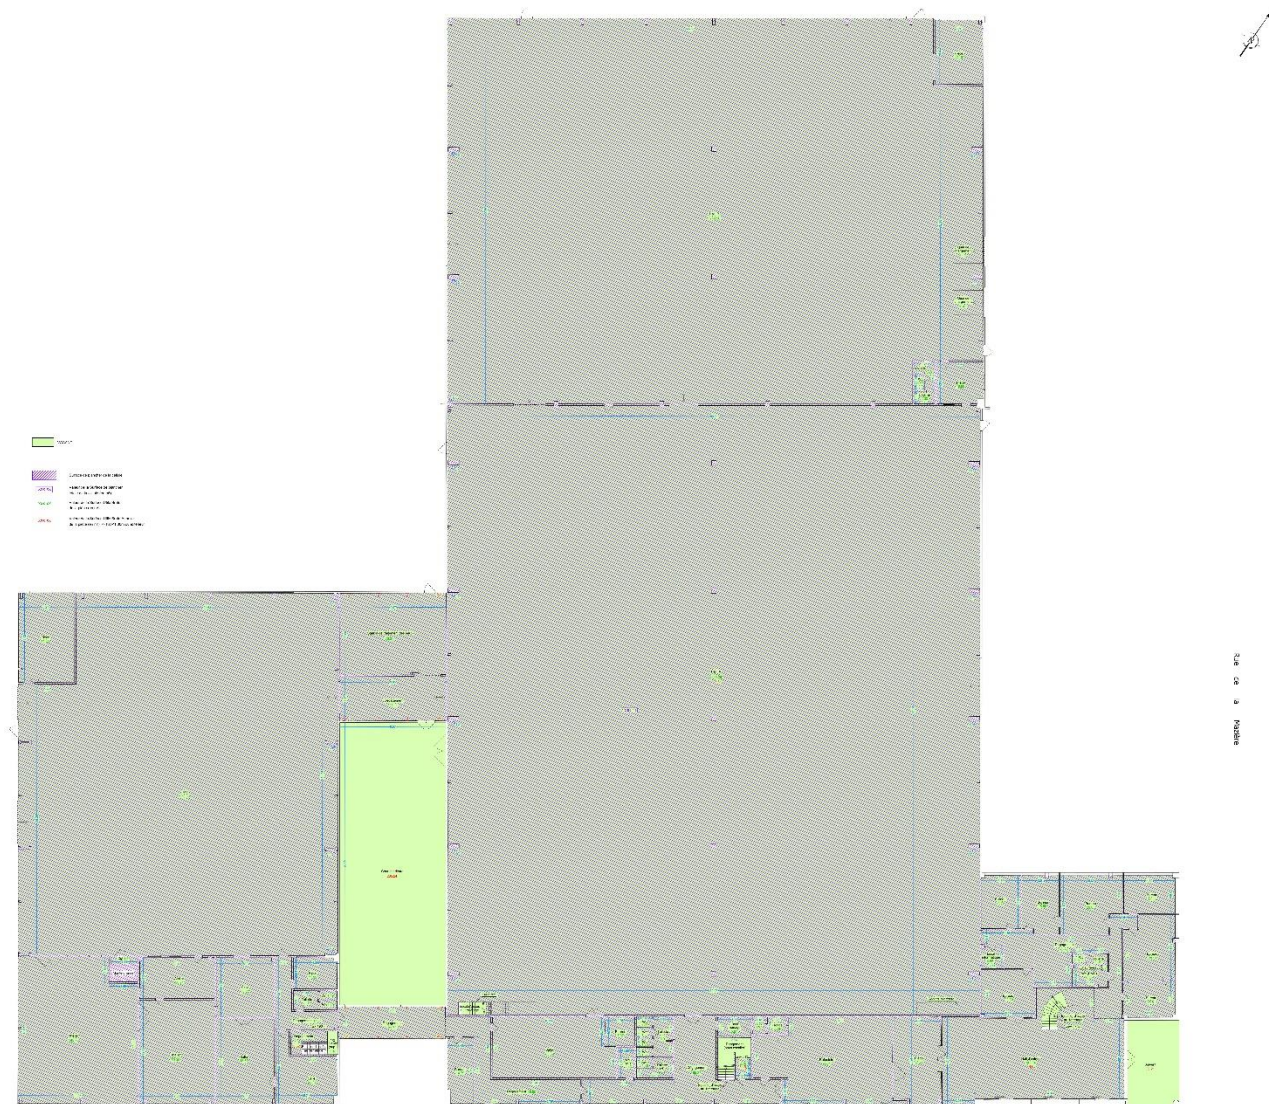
Plan de détail du bâtiment existant : rez de chaussée
